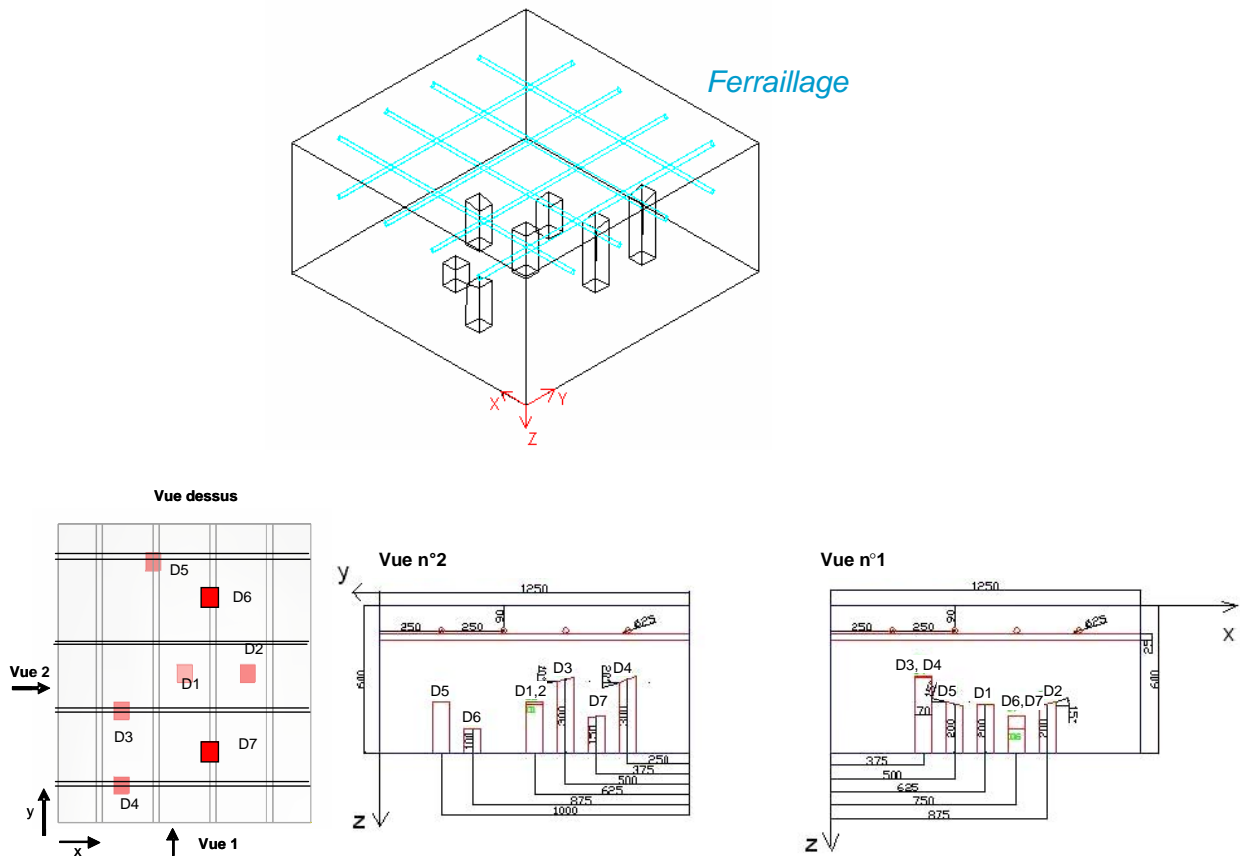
Bloc ferrillé, position des défauts, dimensions du bloc et définition des axes.
